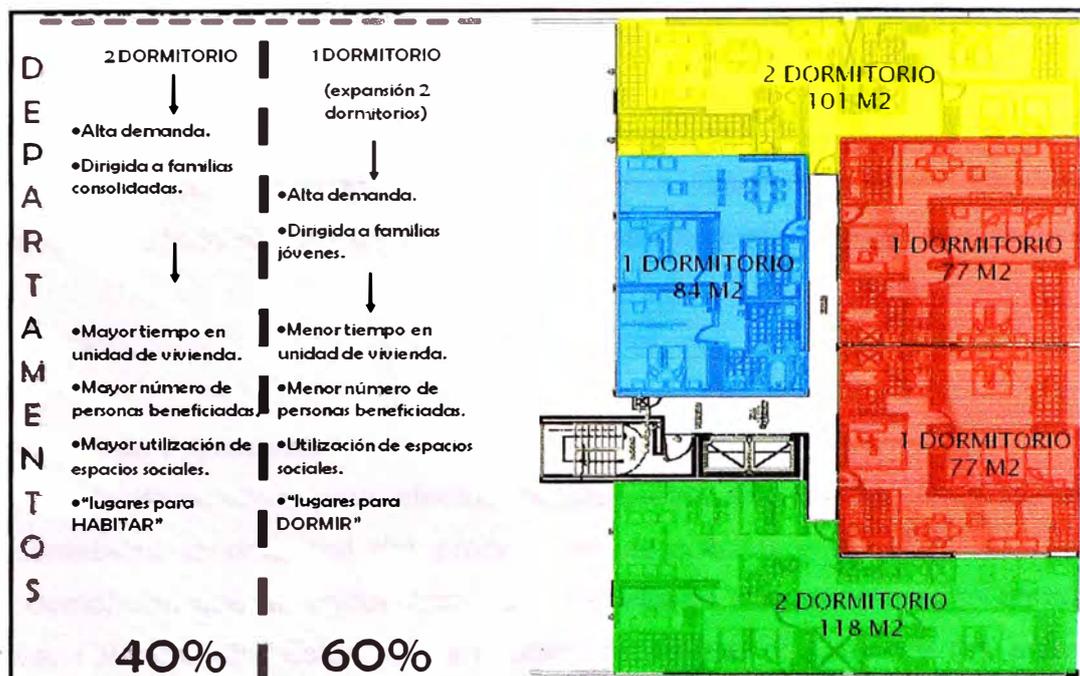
Disposición de departamentos y sus respectivas áreas construidas.
